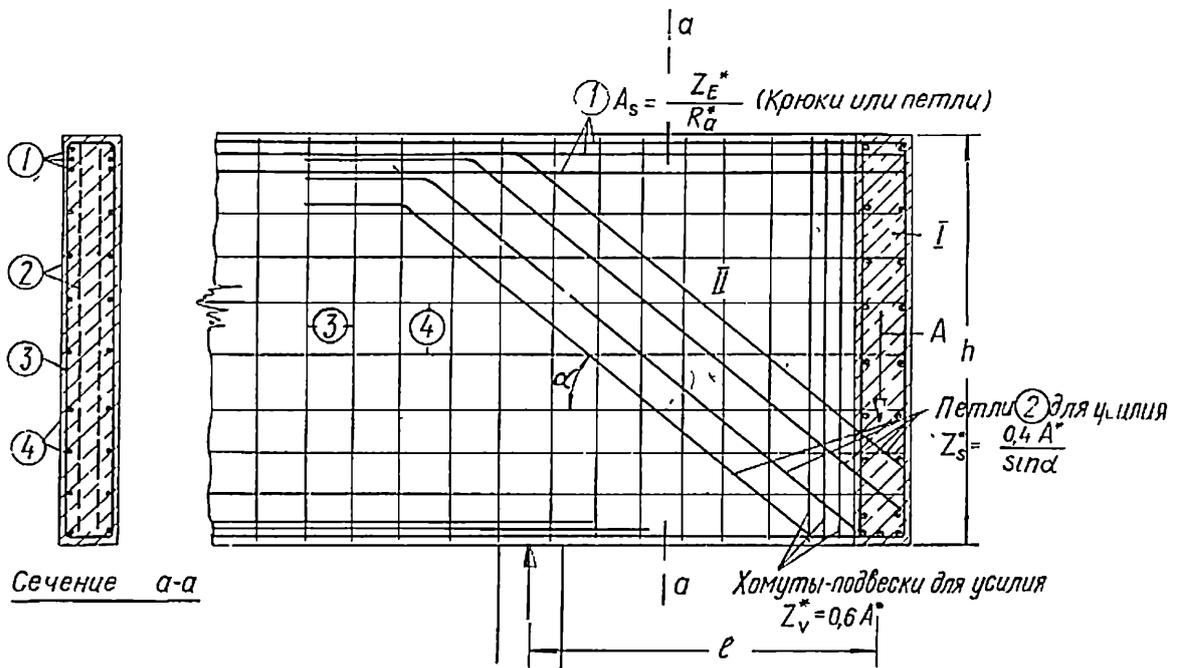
17. Армирование опорной консольной балки-стенки II при высоких уровнях напряжений в месте примыкания балки-стенки I
